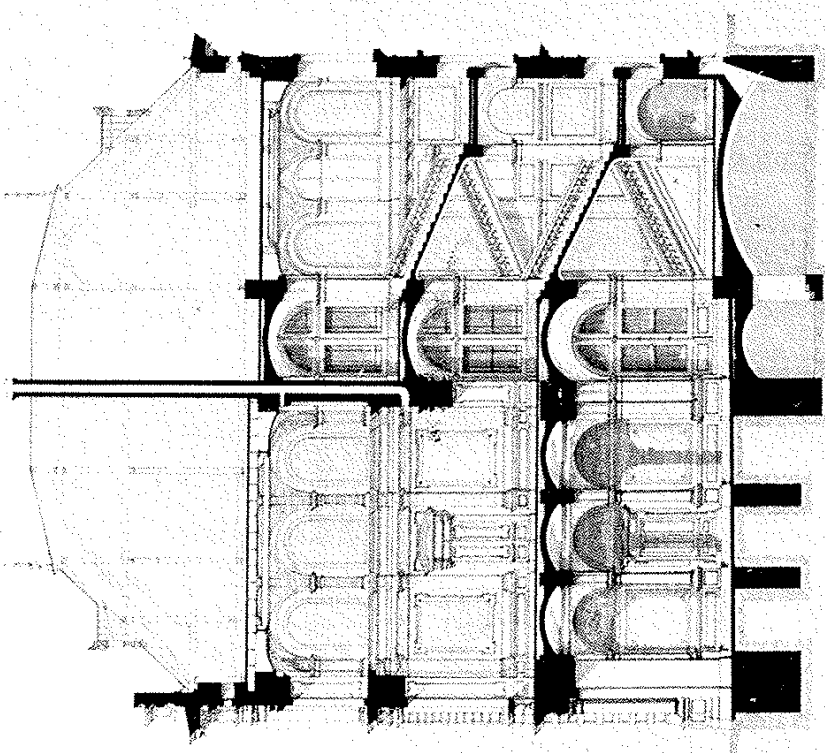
J. Horky: Grundriß des Erdgeschosses
